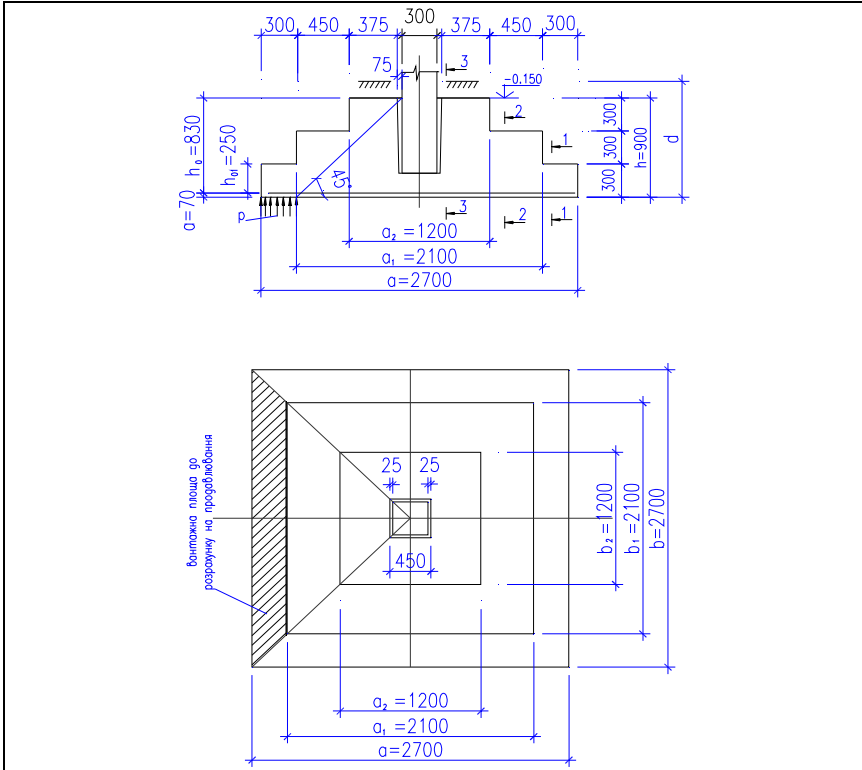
Розрахункова й компоновальна схема фундаменту.
